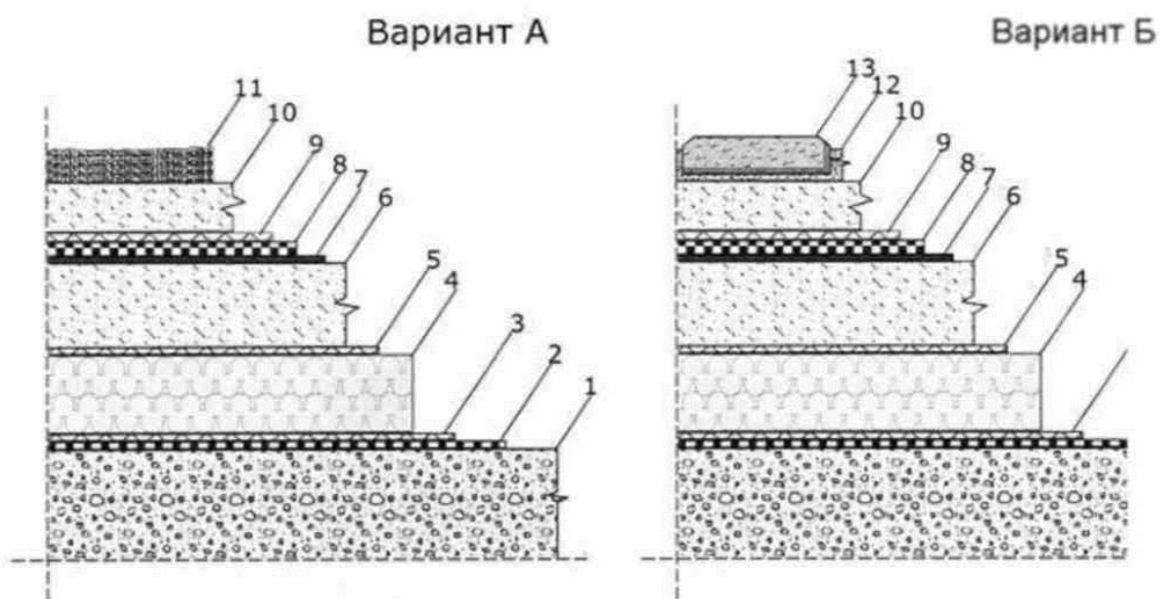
Гидроизоляция фундаментной стены с теплоизоляционным слоем
